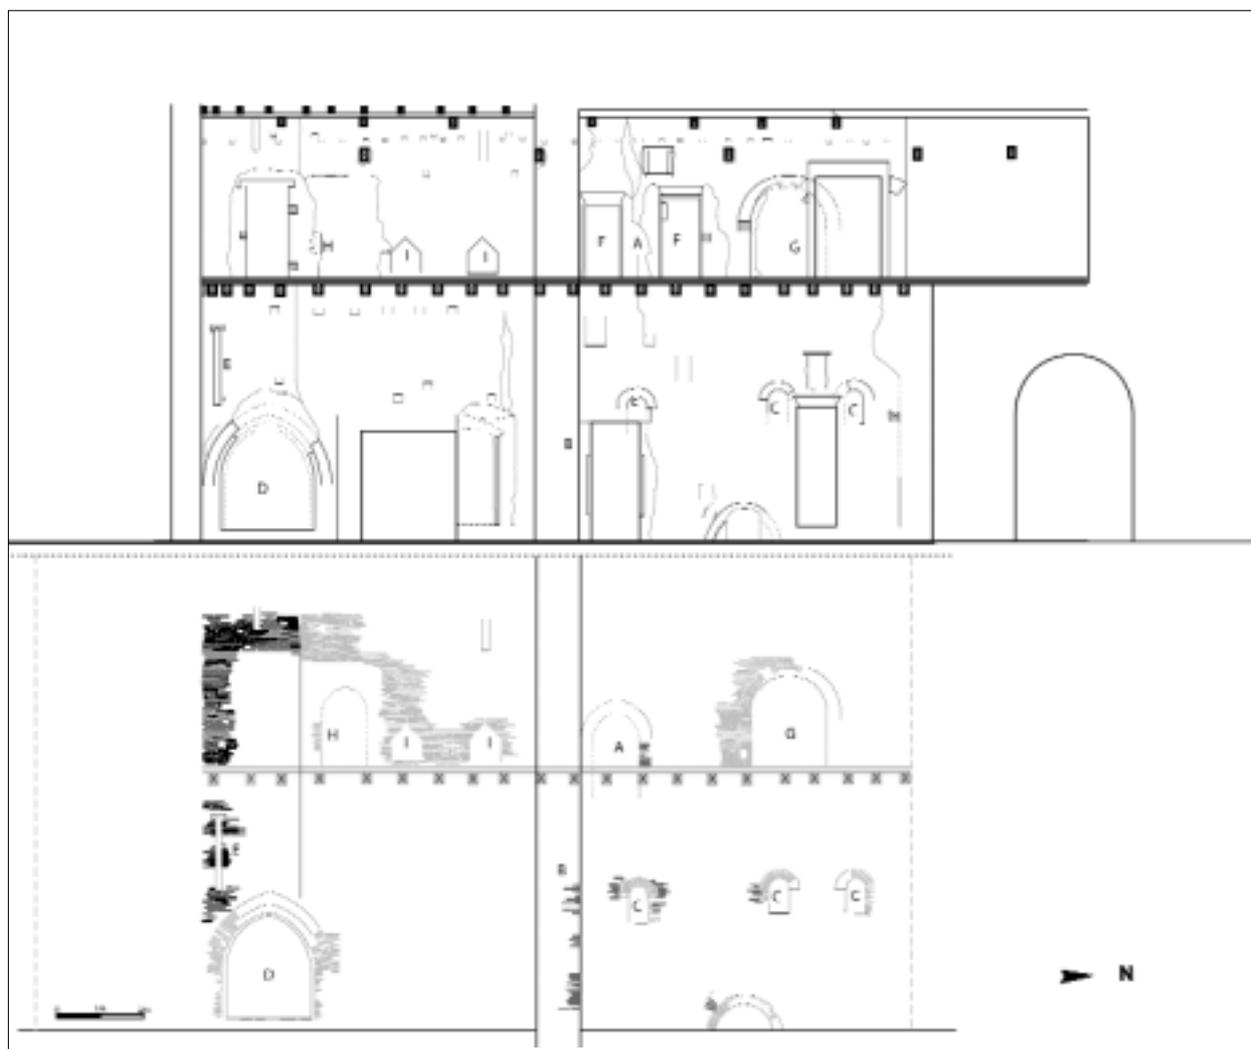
FAÇADE SUR COUR DE L'AILE OUEST.
